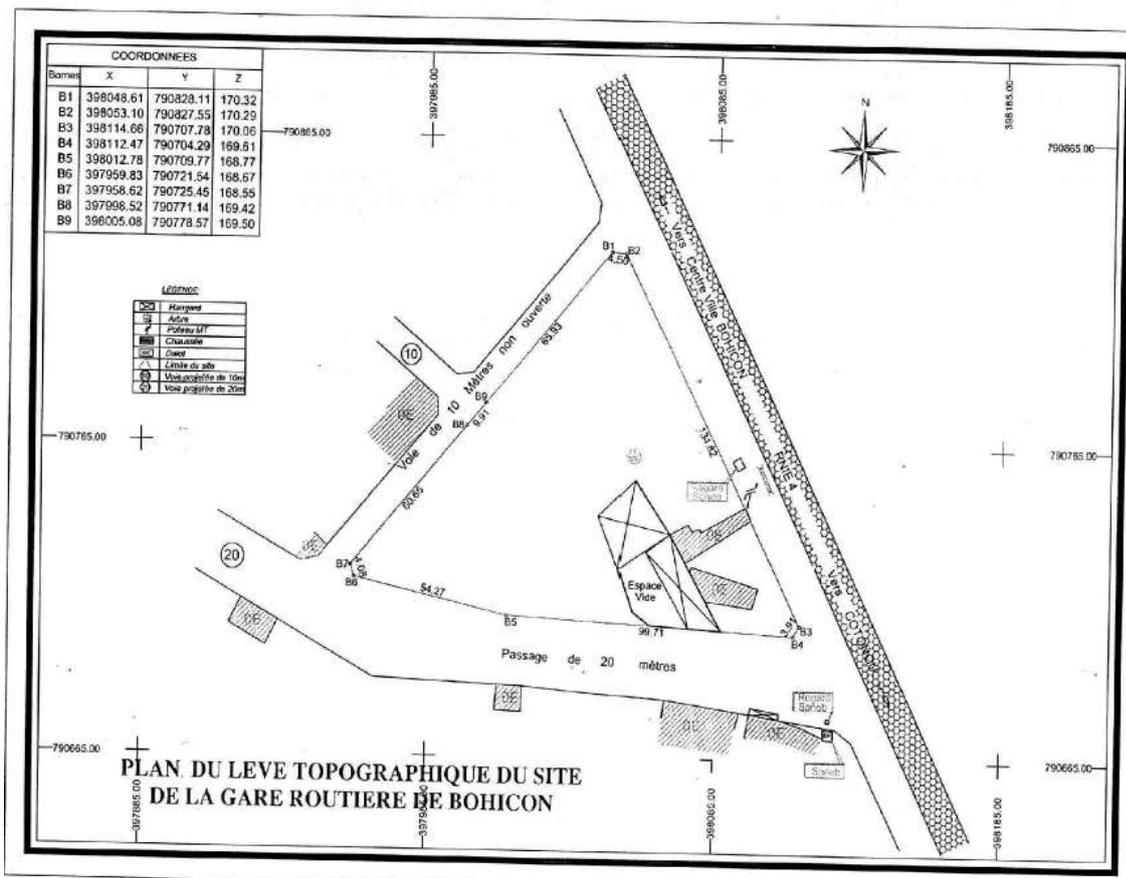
Plan de masse de la gare routière de Bohicon
